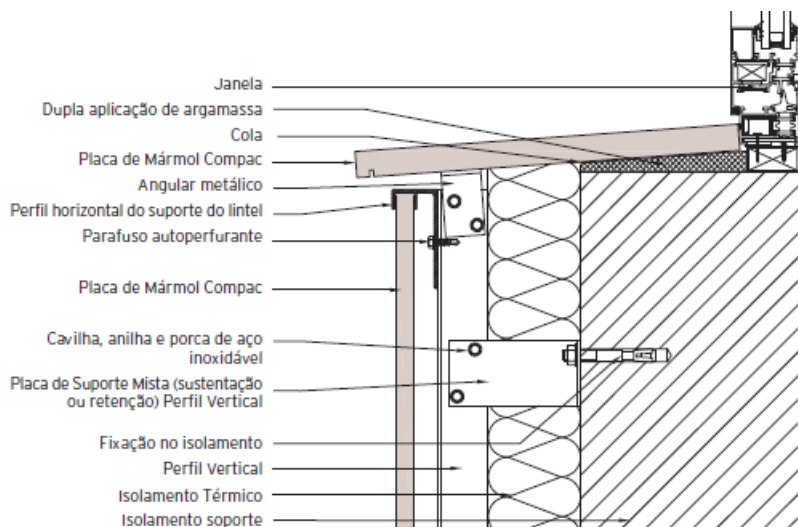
Detalhe construtivo de remate inferior – Goteira [79].
